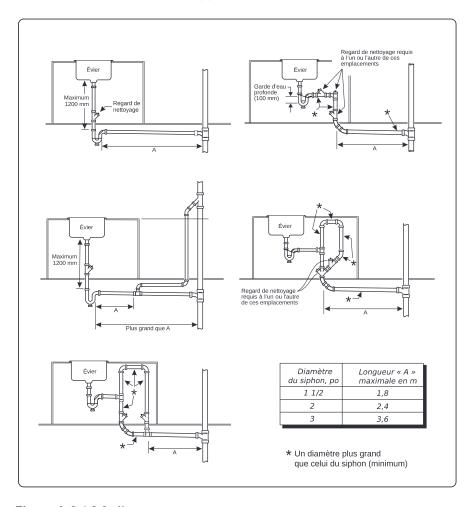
1) Installation des appareils sanitaires des meubles îlots
